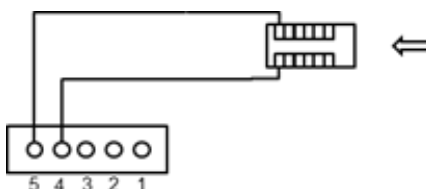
Schema di collegamento con umidostato a funzionamento consenso di asservimento/ventilazione
